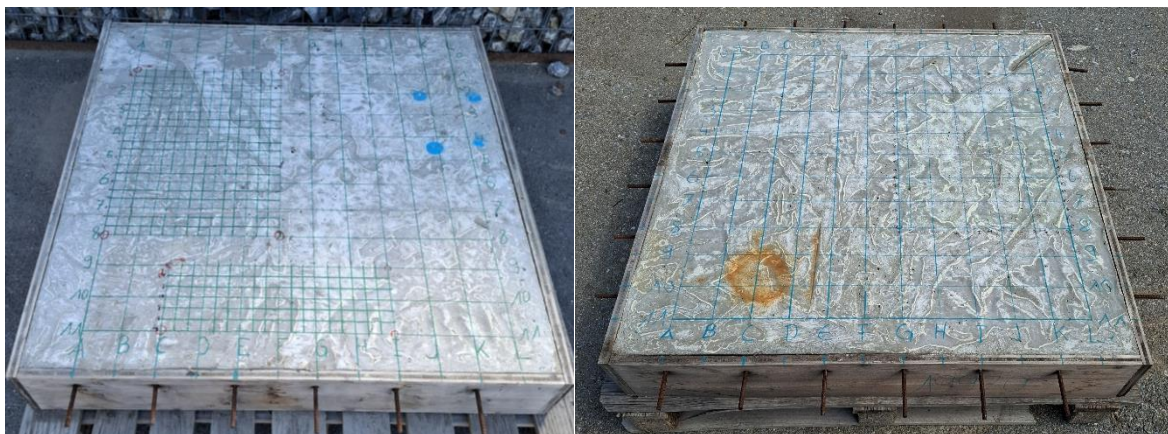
UHFB-Proben mit Bewehrung, links: Einfachbewehrung; rechts: Zweifachbewehrung.
